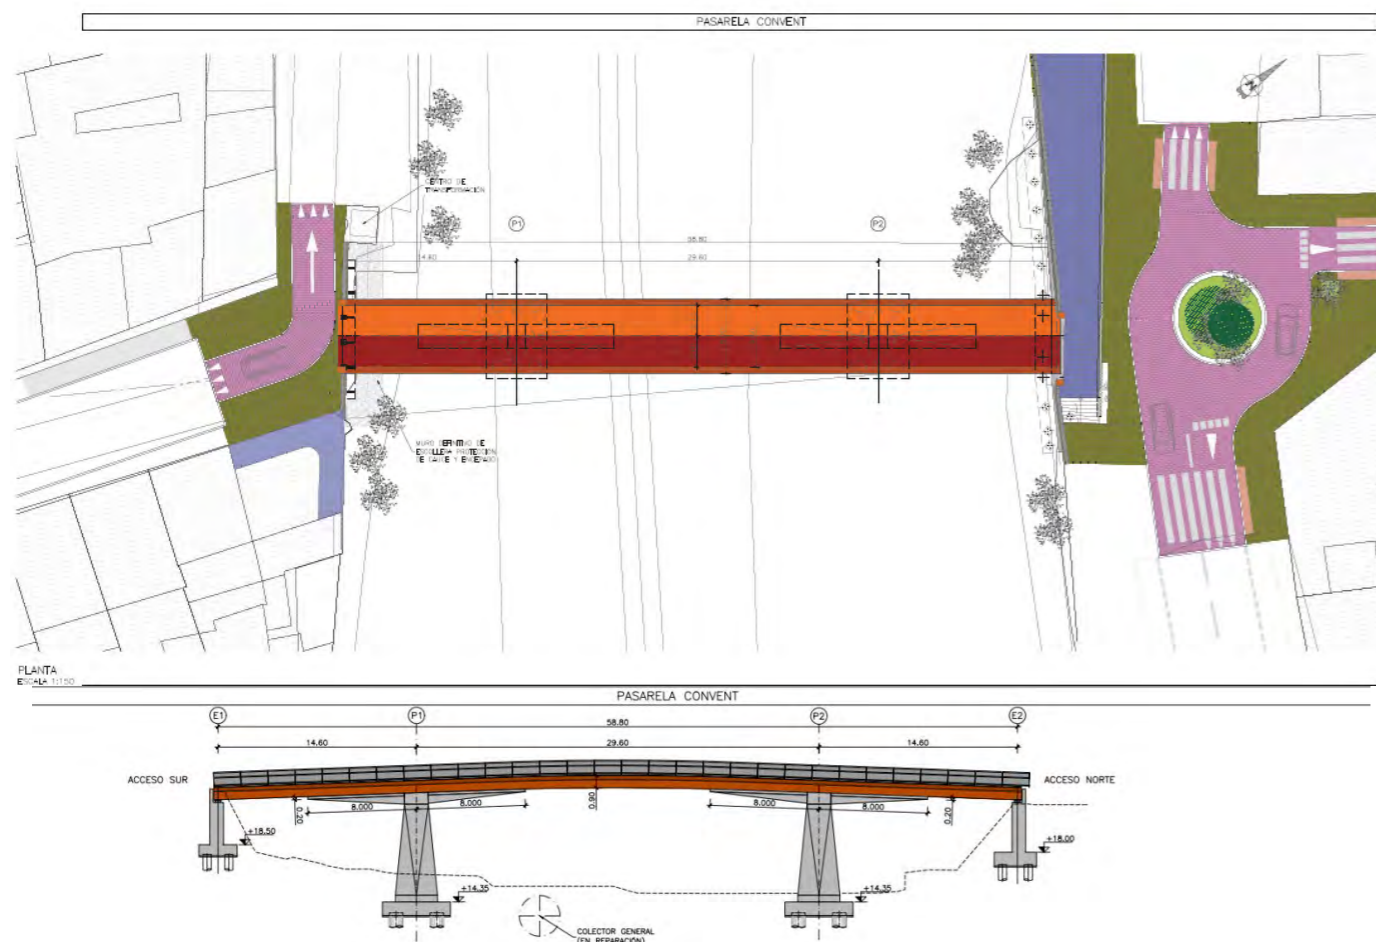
Planta y alzado de la pasarela del Carrer Convent
